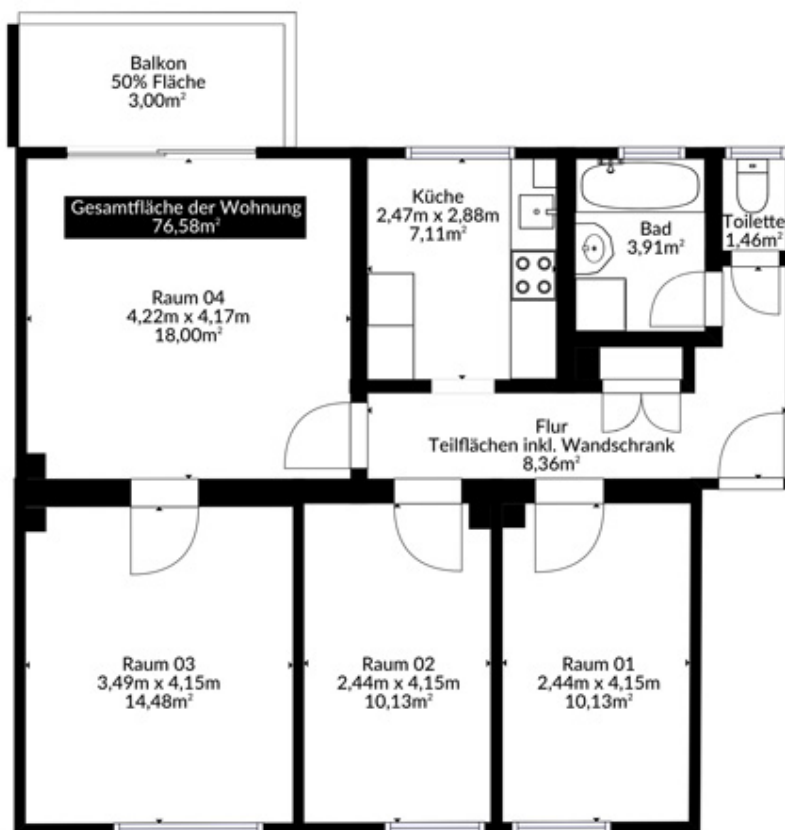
Übergabener Grundriss der Wohnung (Maße und Bezeichnungen wie im Plan vermerkt).
